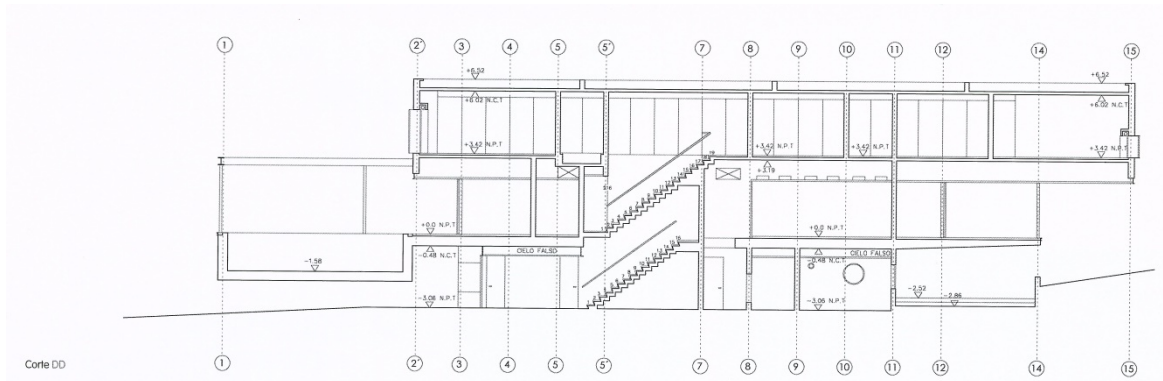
Sección detalles_ “ARQ Ediciones – Mathias Klotz”
